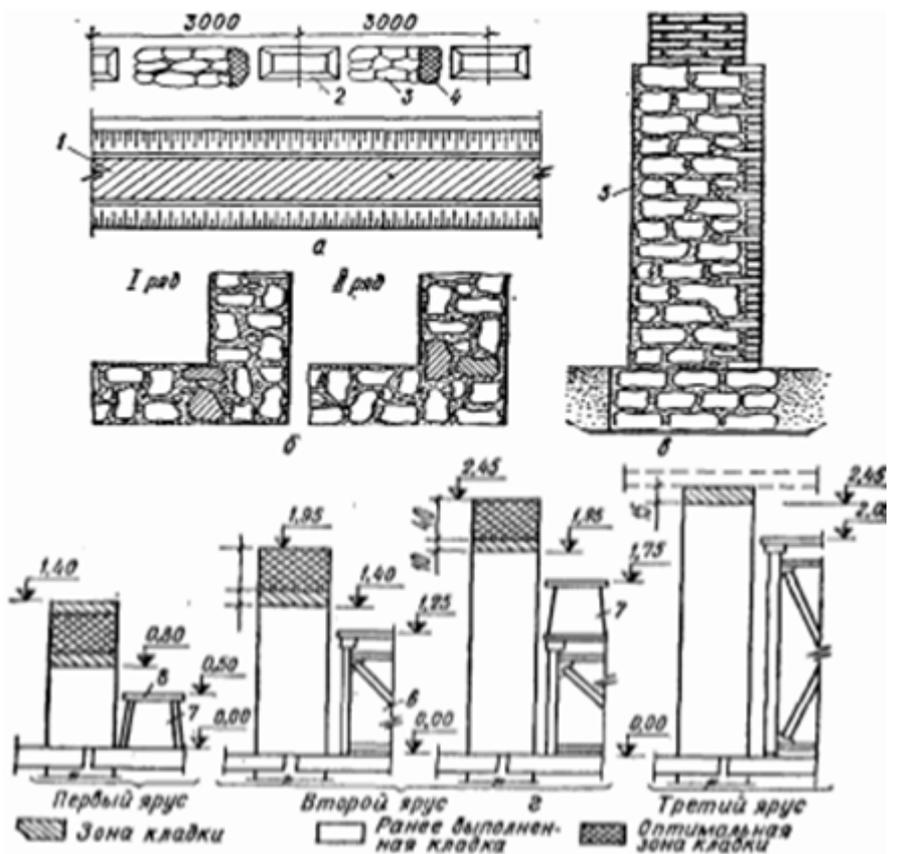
Кладка фундаментов и стен из природного камня неправильной формы:
